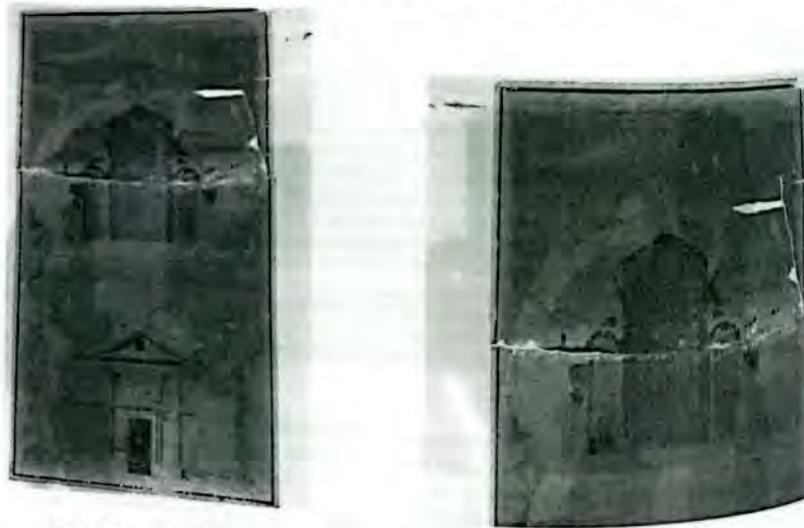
Plano de 1792 - Alzado y sección transversal de la Iglesia de San Juan en Écija (Sevilla).
